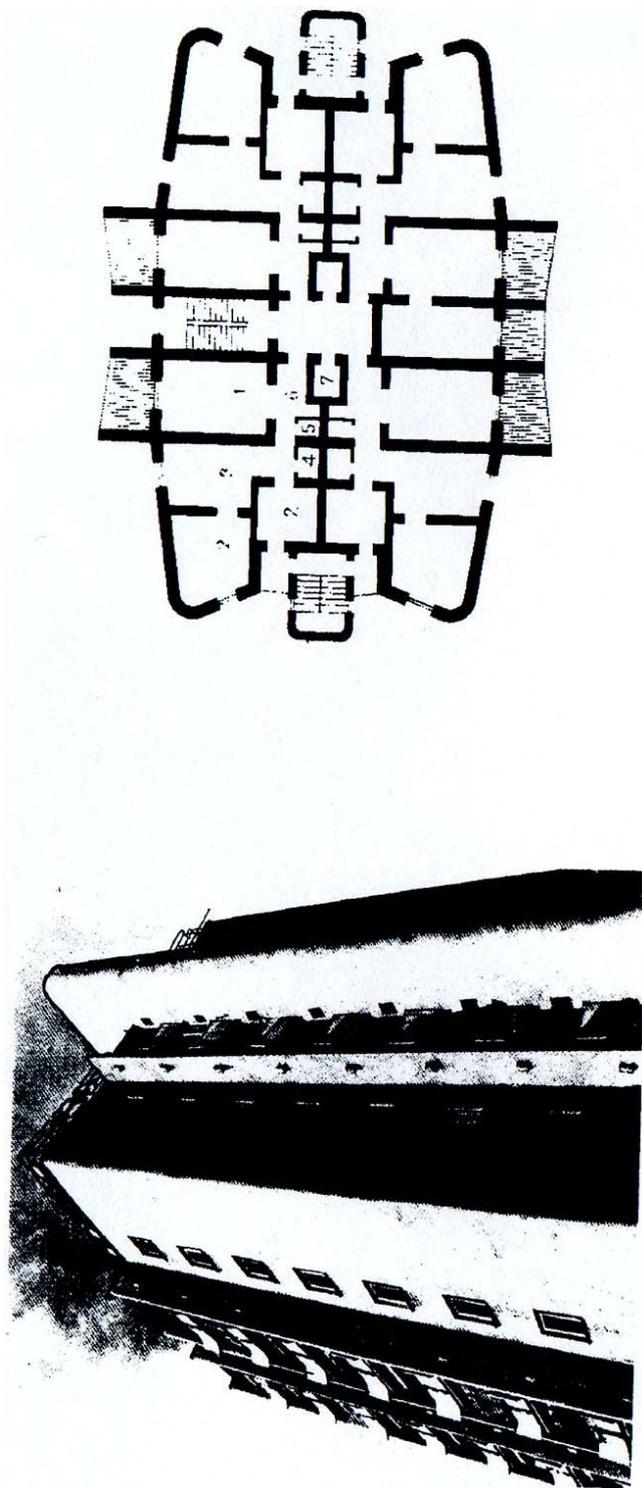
12-этажный жилой дом из монолитного железобетона (г. Алматы).
